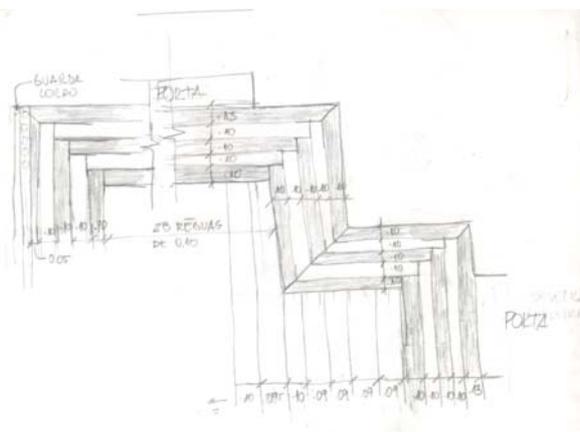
Croqui para levantamento métrico do piso. Fonte: Projeto de Restauo RB762 - UFRJ, 2004.
